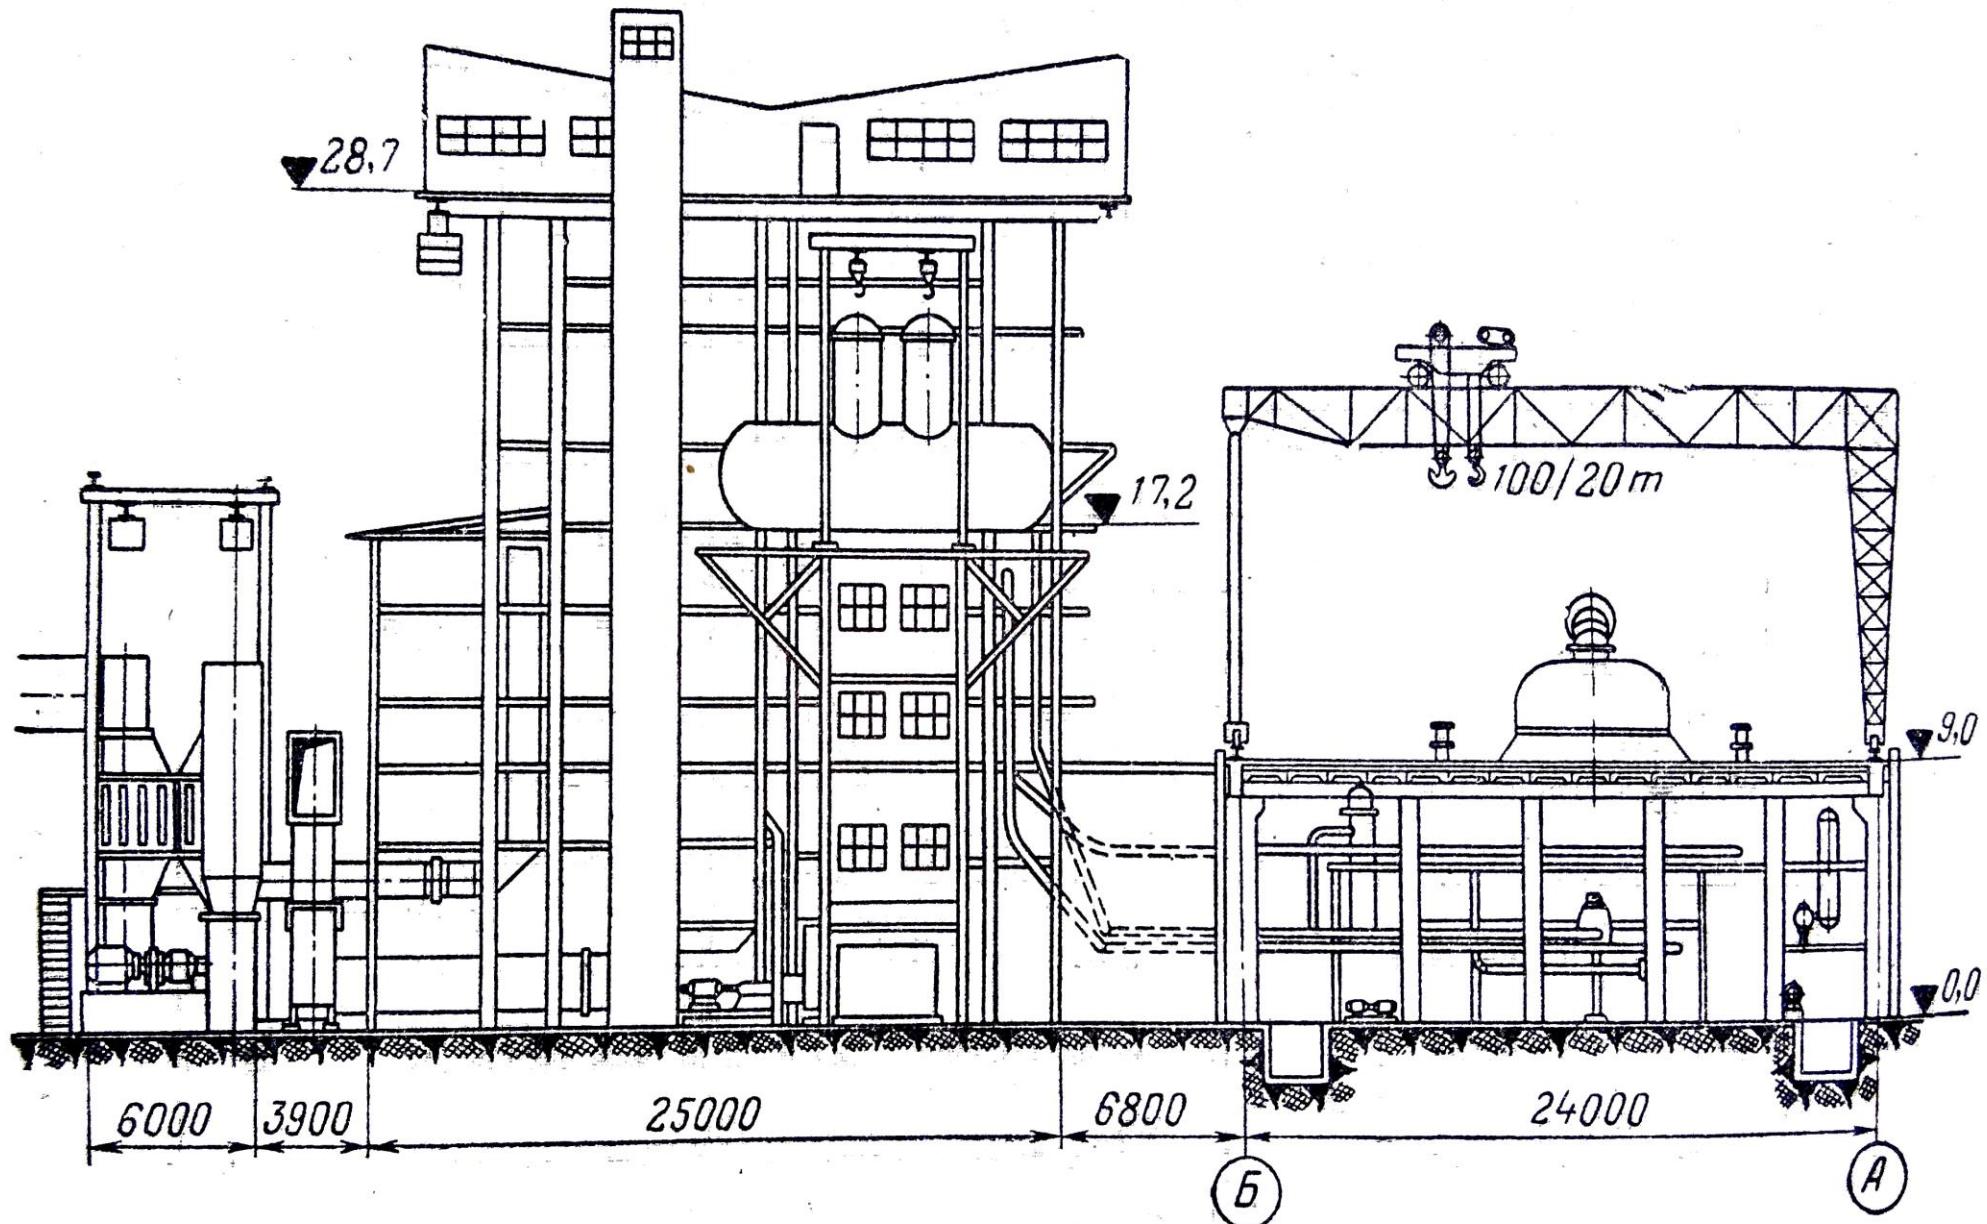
Поперечный разрез по главному корпусу ТЭС открытого типа.
